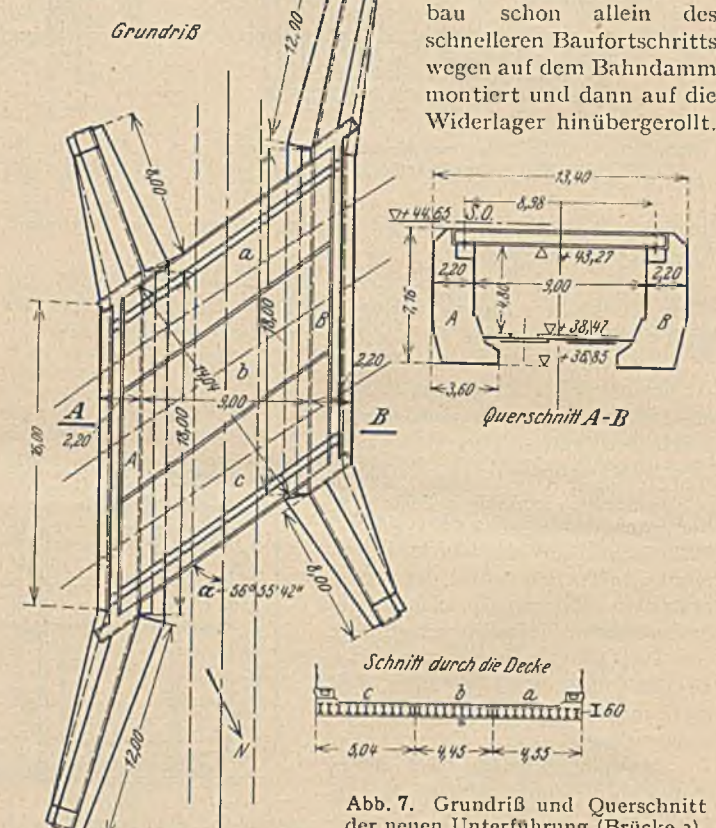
Grundriß und Querschnitt der neuen Unterführung (Brücke 3).
